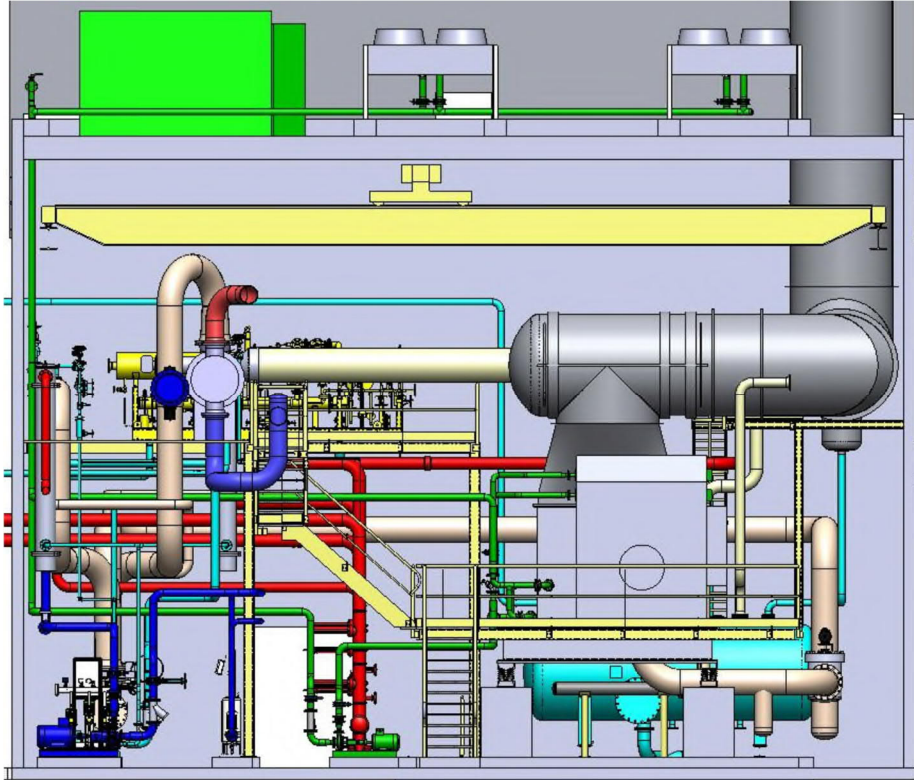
Vue 3D en coupe tuyauterie et GTA
